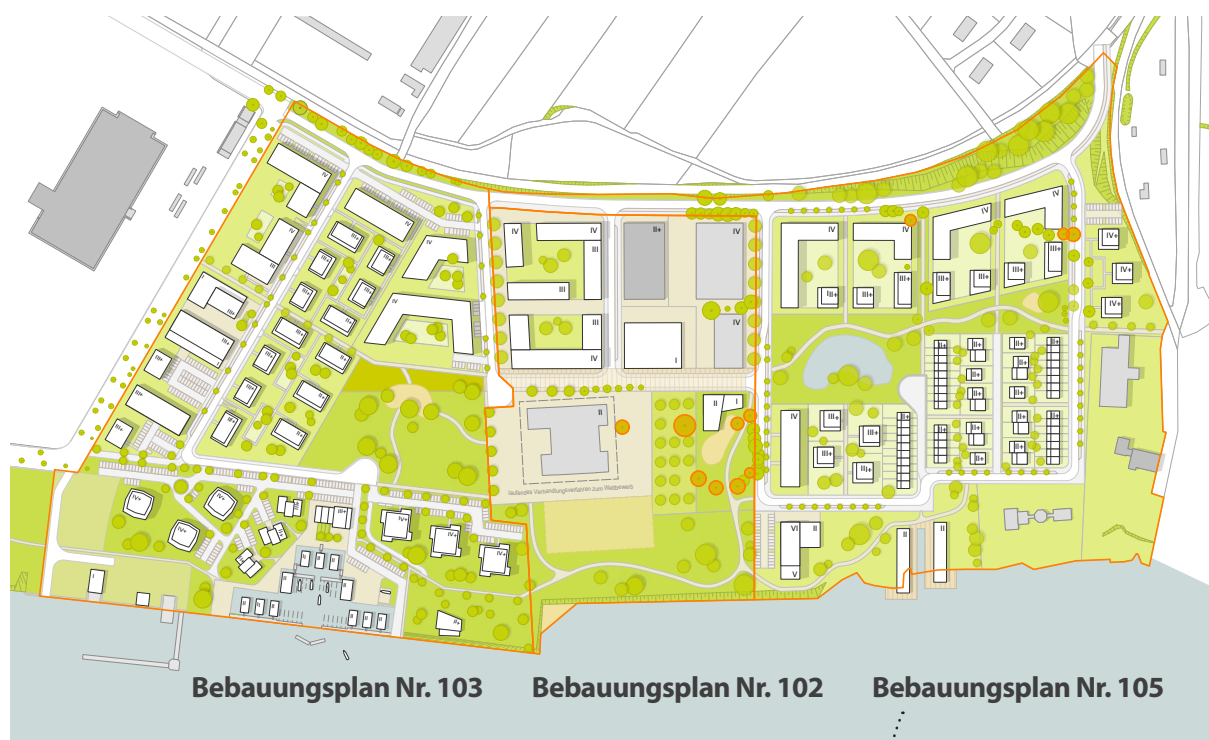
// Städtebaulicher Rahmenplan 2020 mit Bebauungsplanbereichen
